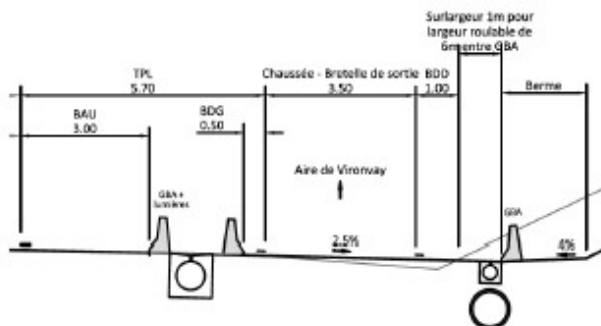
Pt type bretelle d'entrée aire de Viroyway
